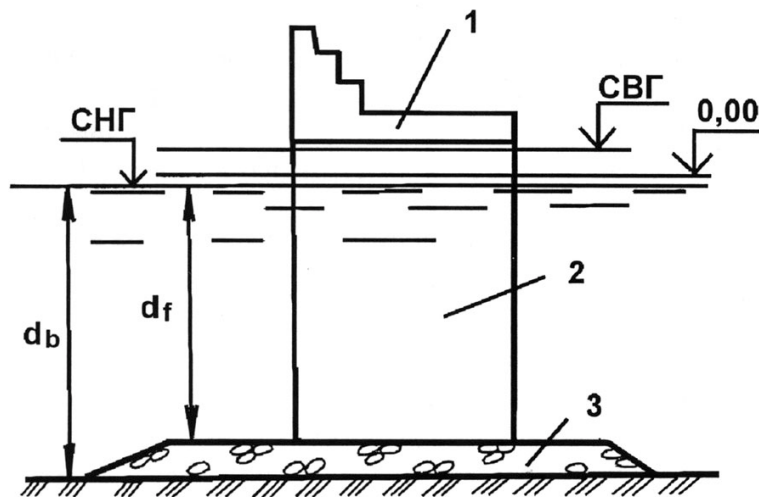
Схема сооружения типа гравитационной вертикальной стенки:
